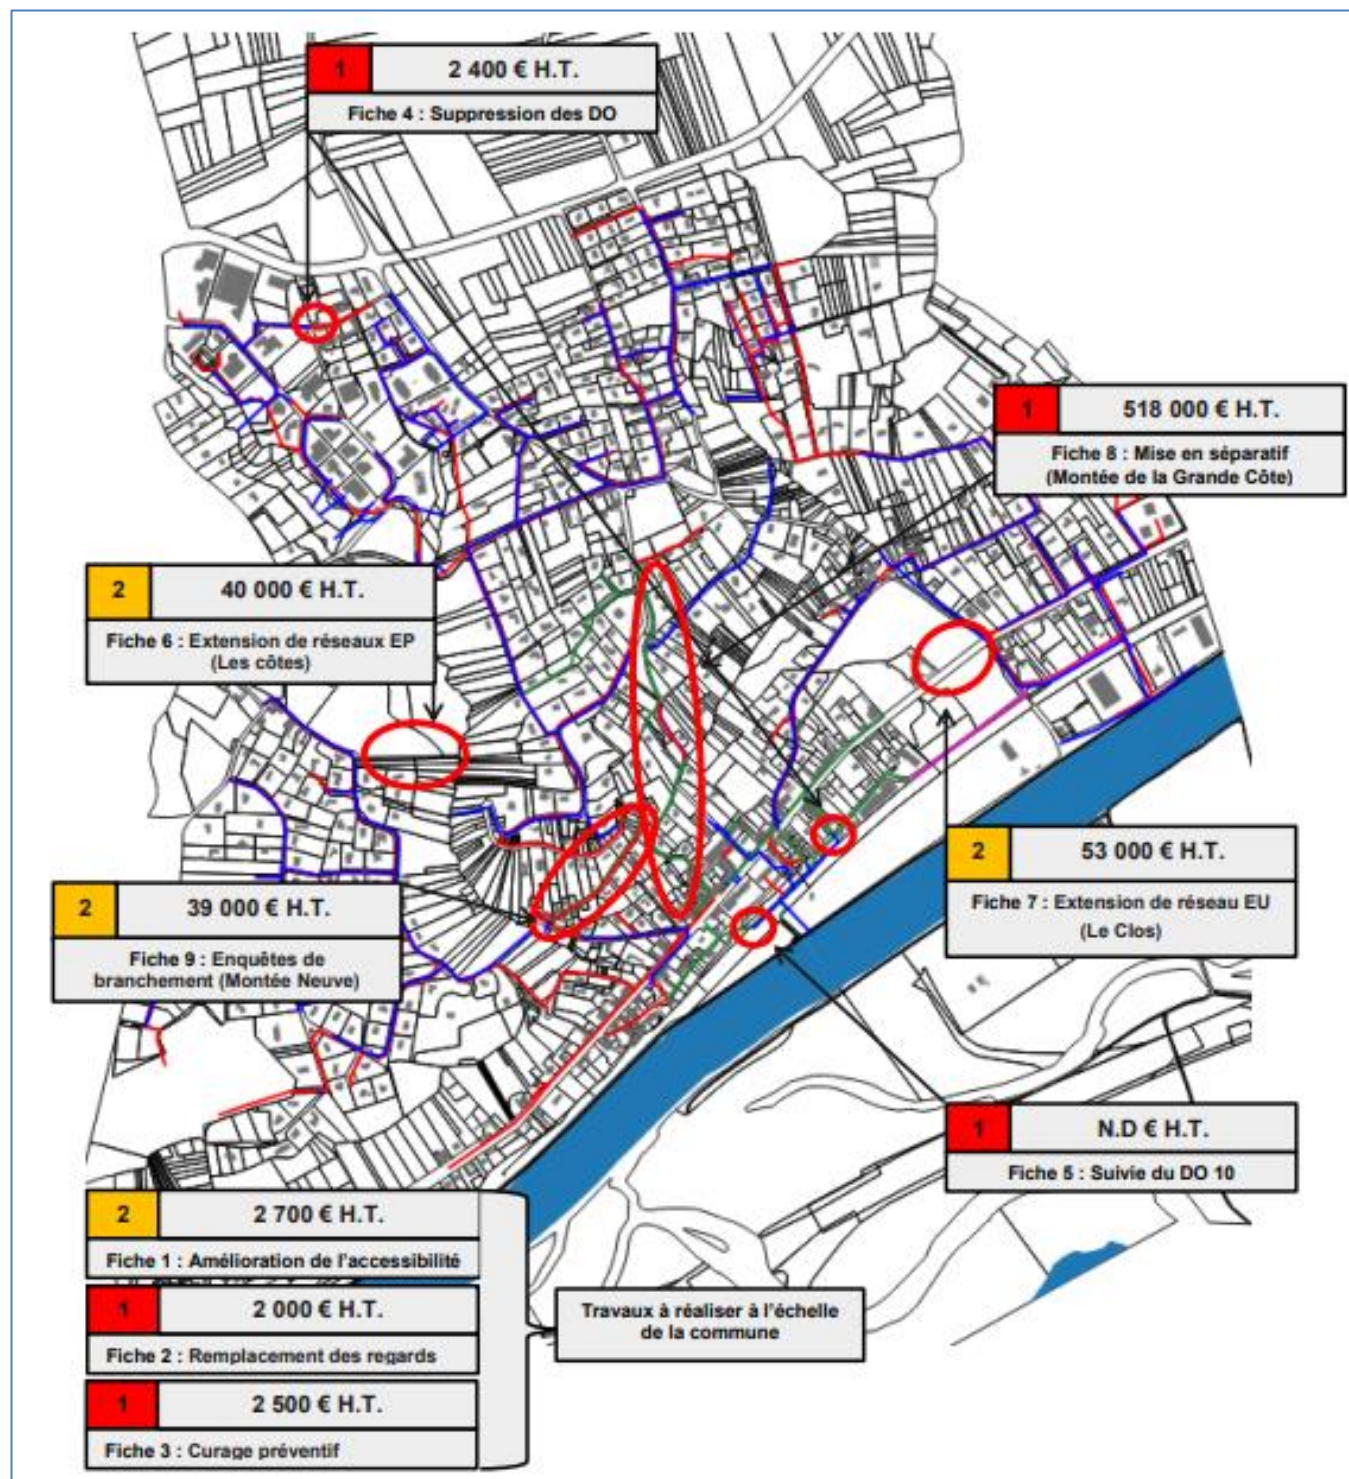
PLAN DES TRAVAUX SUR NEYRON
